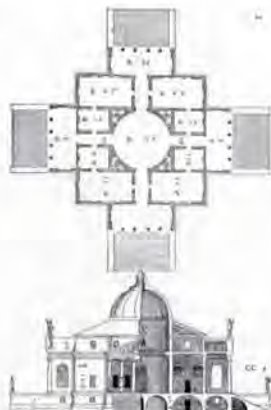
Andrea Palladio: planta y alzado de la Villa Rotonda, Vicenza (en Palladio: *Quattro libri dell'Architettura*, Venecia, 1570)
